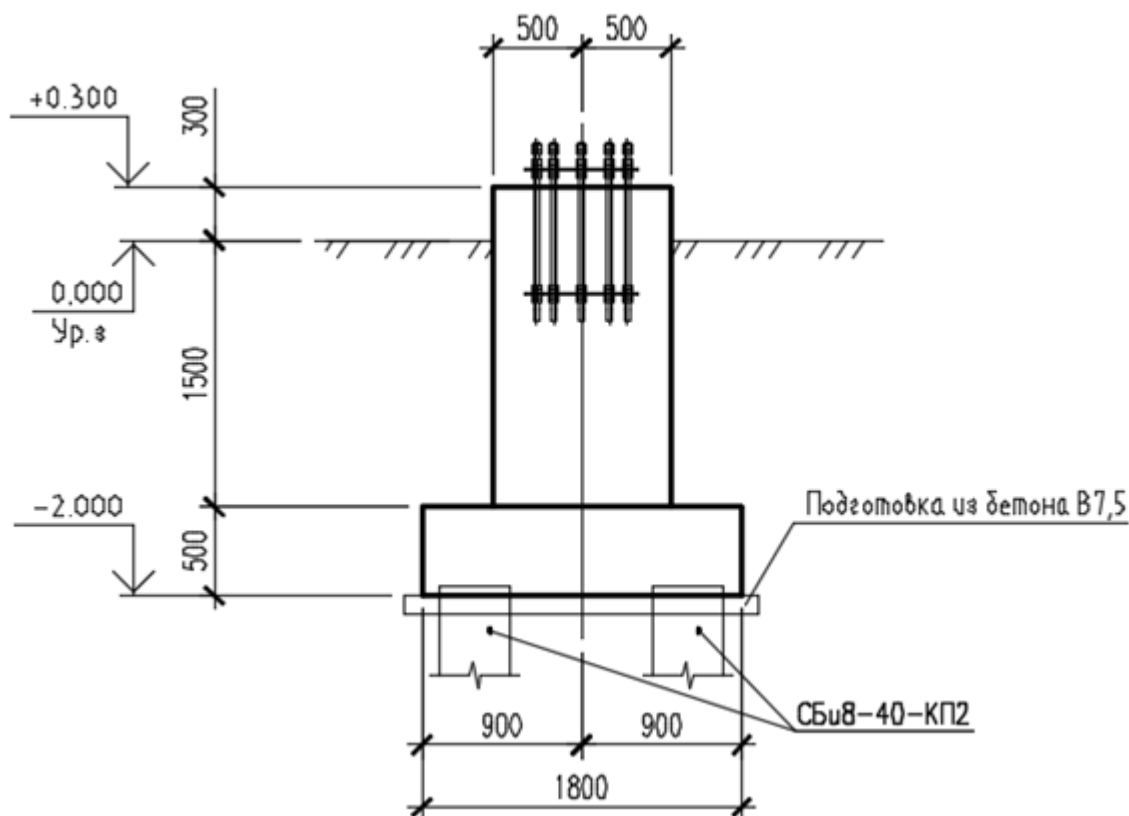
Разработанный вариант свайного фундамента с использованием буровых свай
